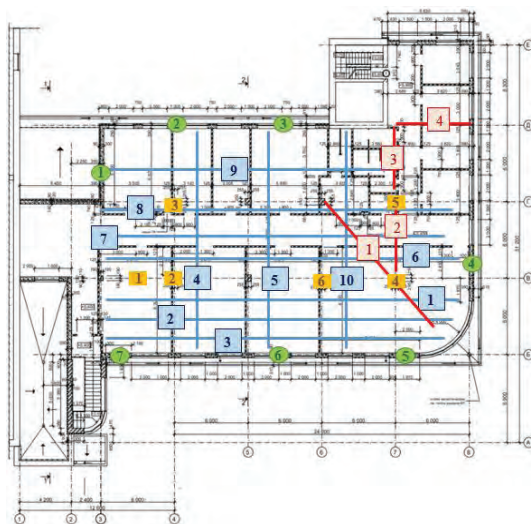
Схема проведения геодезической съёмки на 2 этаже здания (желтым - колонны, красным - балки, синим - пол, зеленым - стены)
